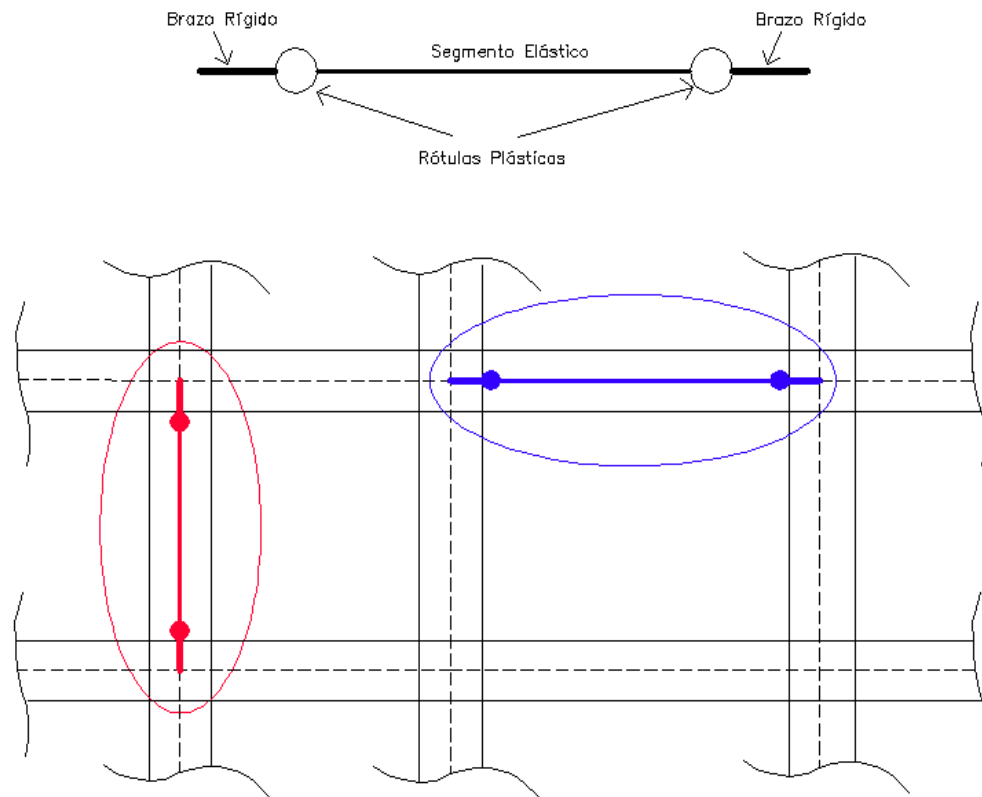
Modelación de vigas y columnas en edificios aporticados
